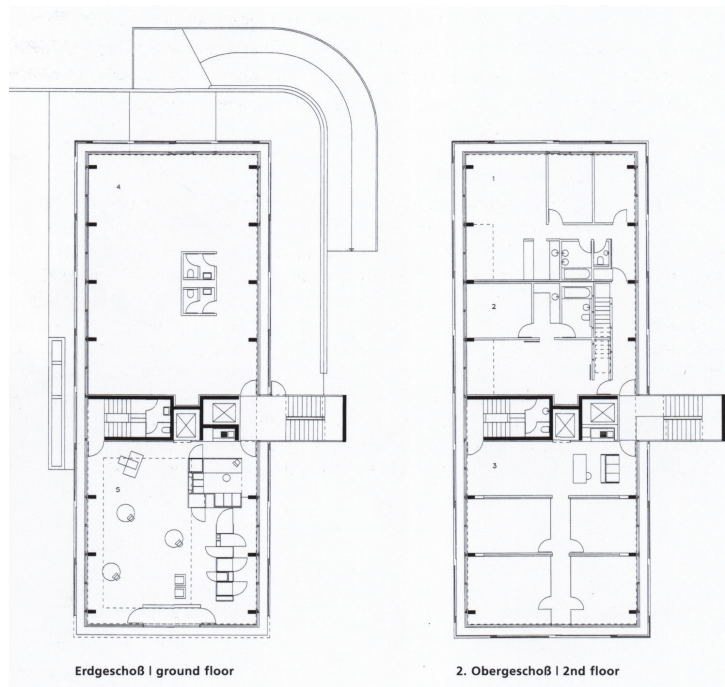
Grundrisse Büro- und Wohnhaus
